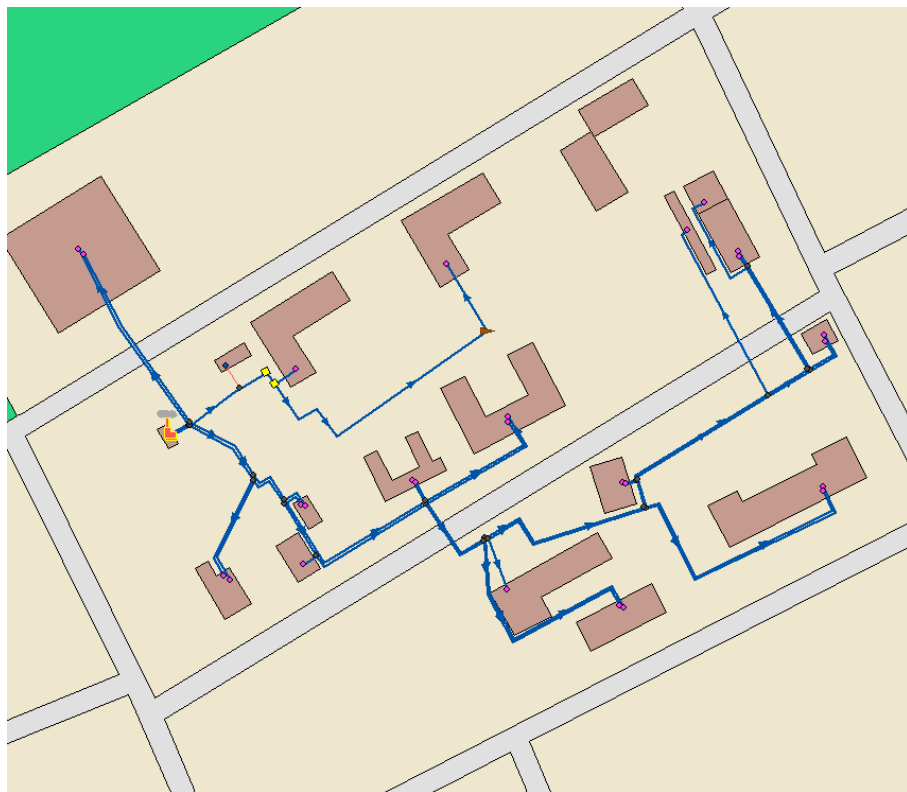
Схема тепловых сетей от здания котельной ул. Байкальская, дом №26-1 (Школа №11)
